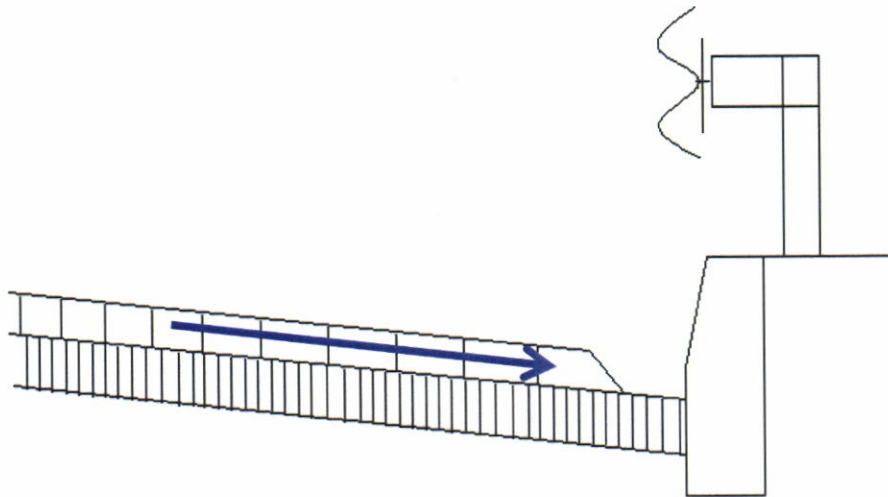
Схема отвода воды с устройством водоотводных лотков. Открытый лоток, устроенный путем укладки верхнего слоя покрытия меньшей на 10 см ширины
